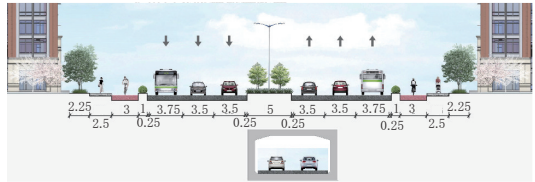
进出站快速通道暗埋段标准横断面示意图(单位:m)
